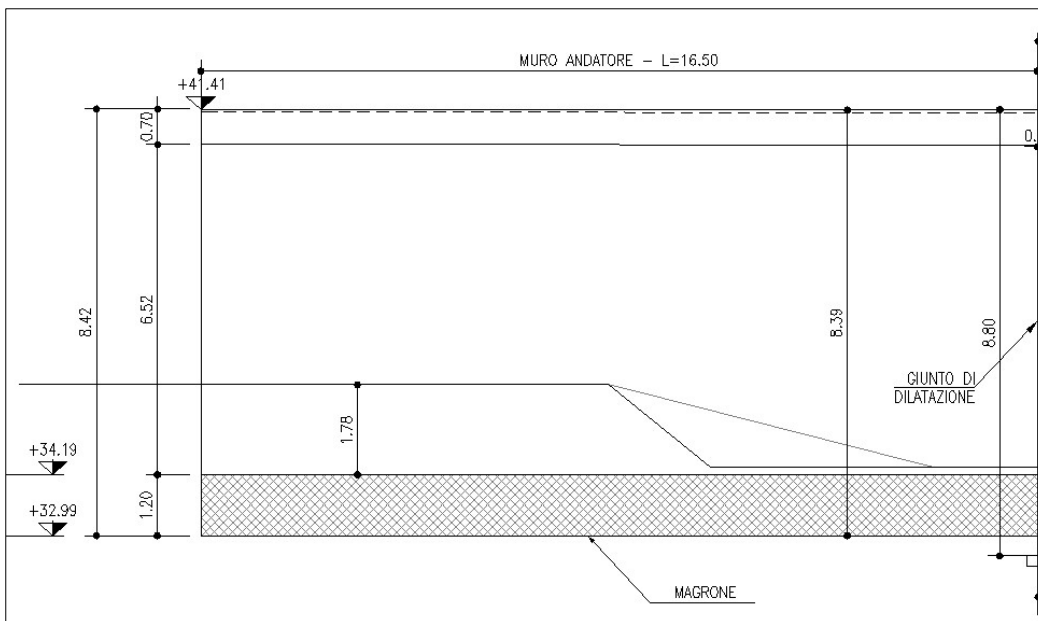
Prospetto del muro andatore lato Rimini - Allargamento Nord
